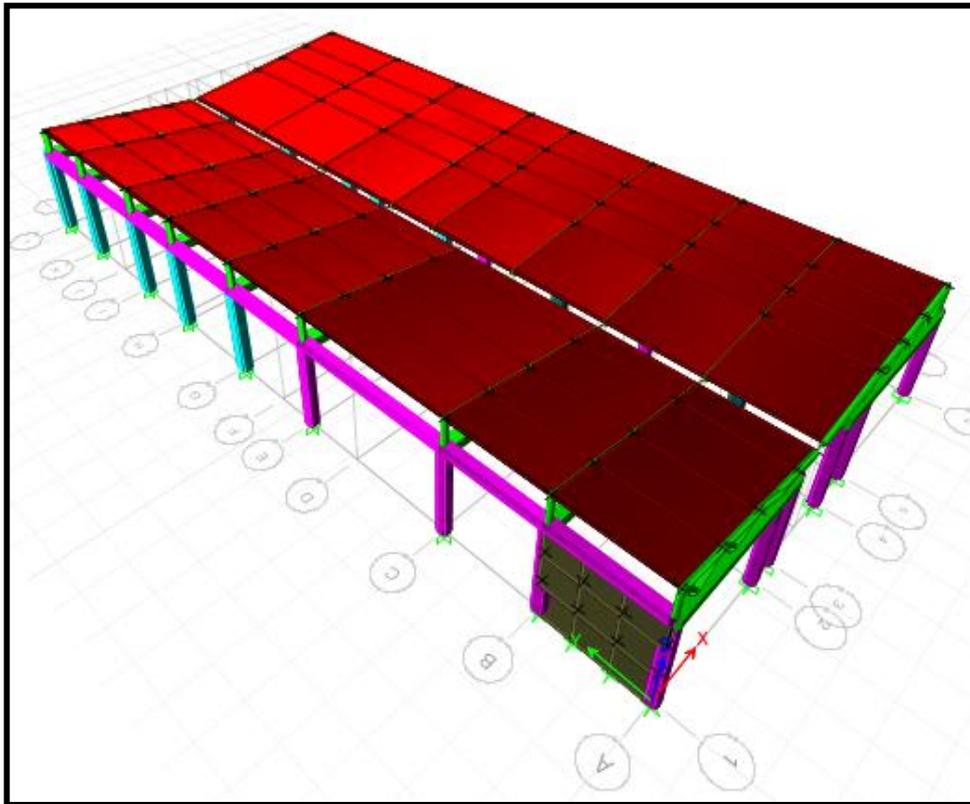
Vista en Planta del piso Proyectado – Nivel Vigas
